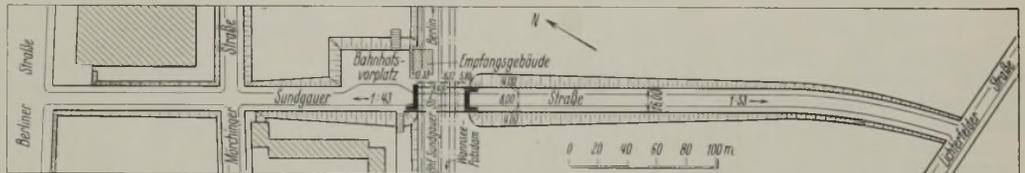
Sundgauer Straßenbrücke. Lageplan.
